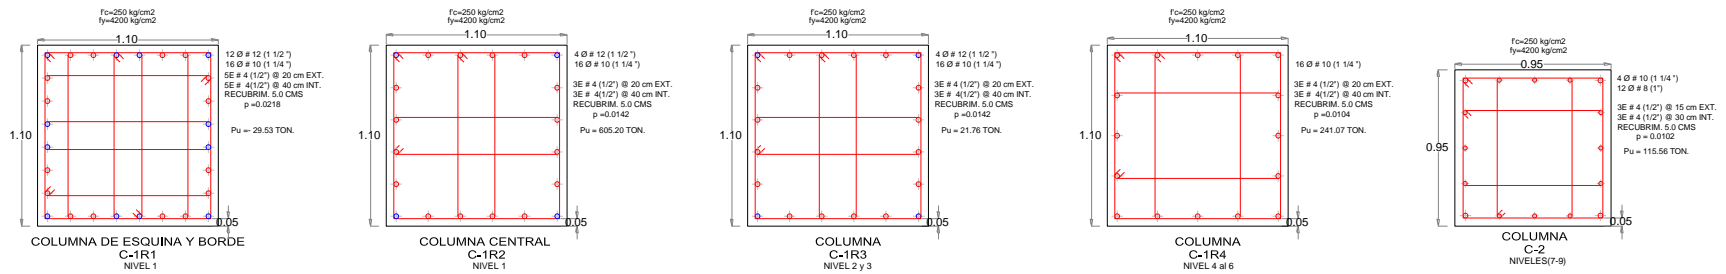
Detallado de armado de columnas de edificio de 9 niveles con base a la hipótesis de las NTCC-17.
